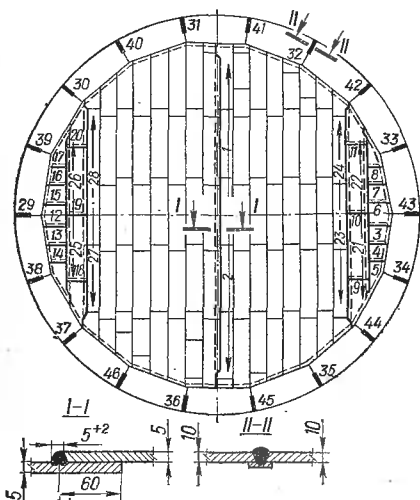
Последовательность при-варки швов к корпусу резервуара (обозначена цифрами):
